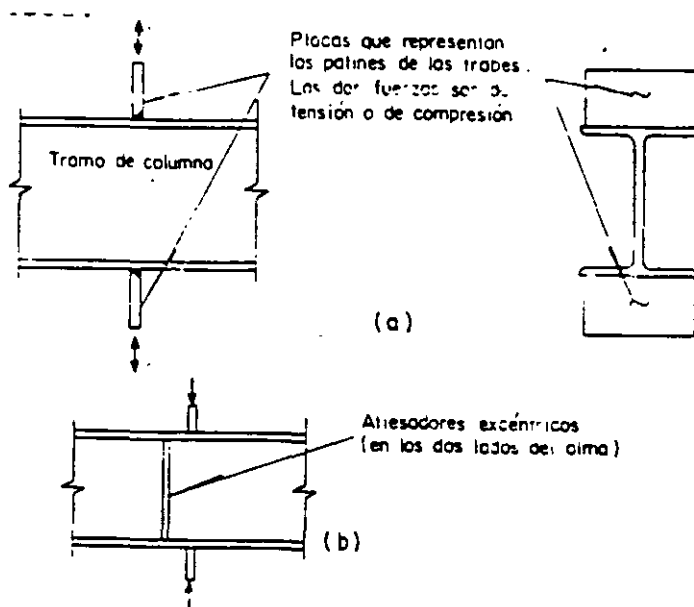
Simulación del efecto de los patines de las vigas en la columna
